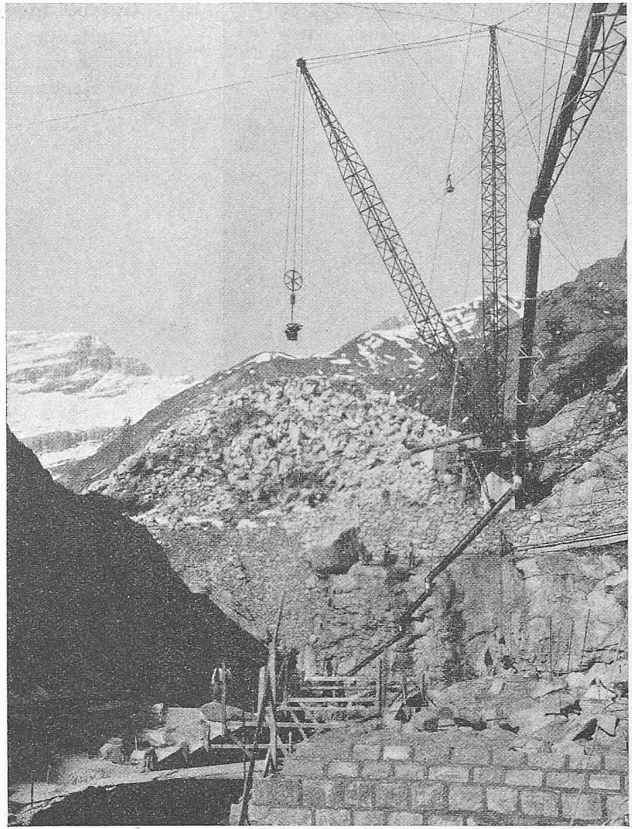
Derrick-Kran an der Staumauer-Baustelle.
